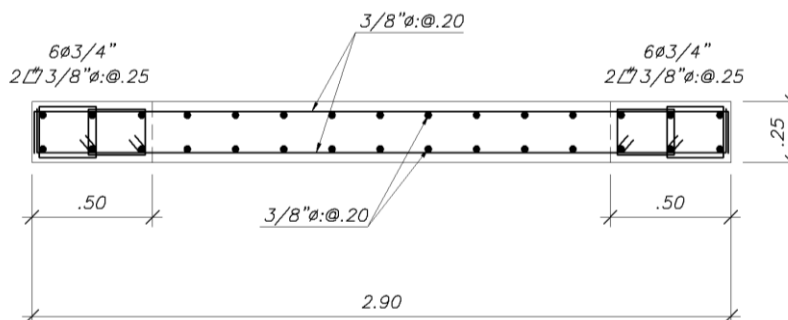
Refuerzo de Placa-1 en primer piso
